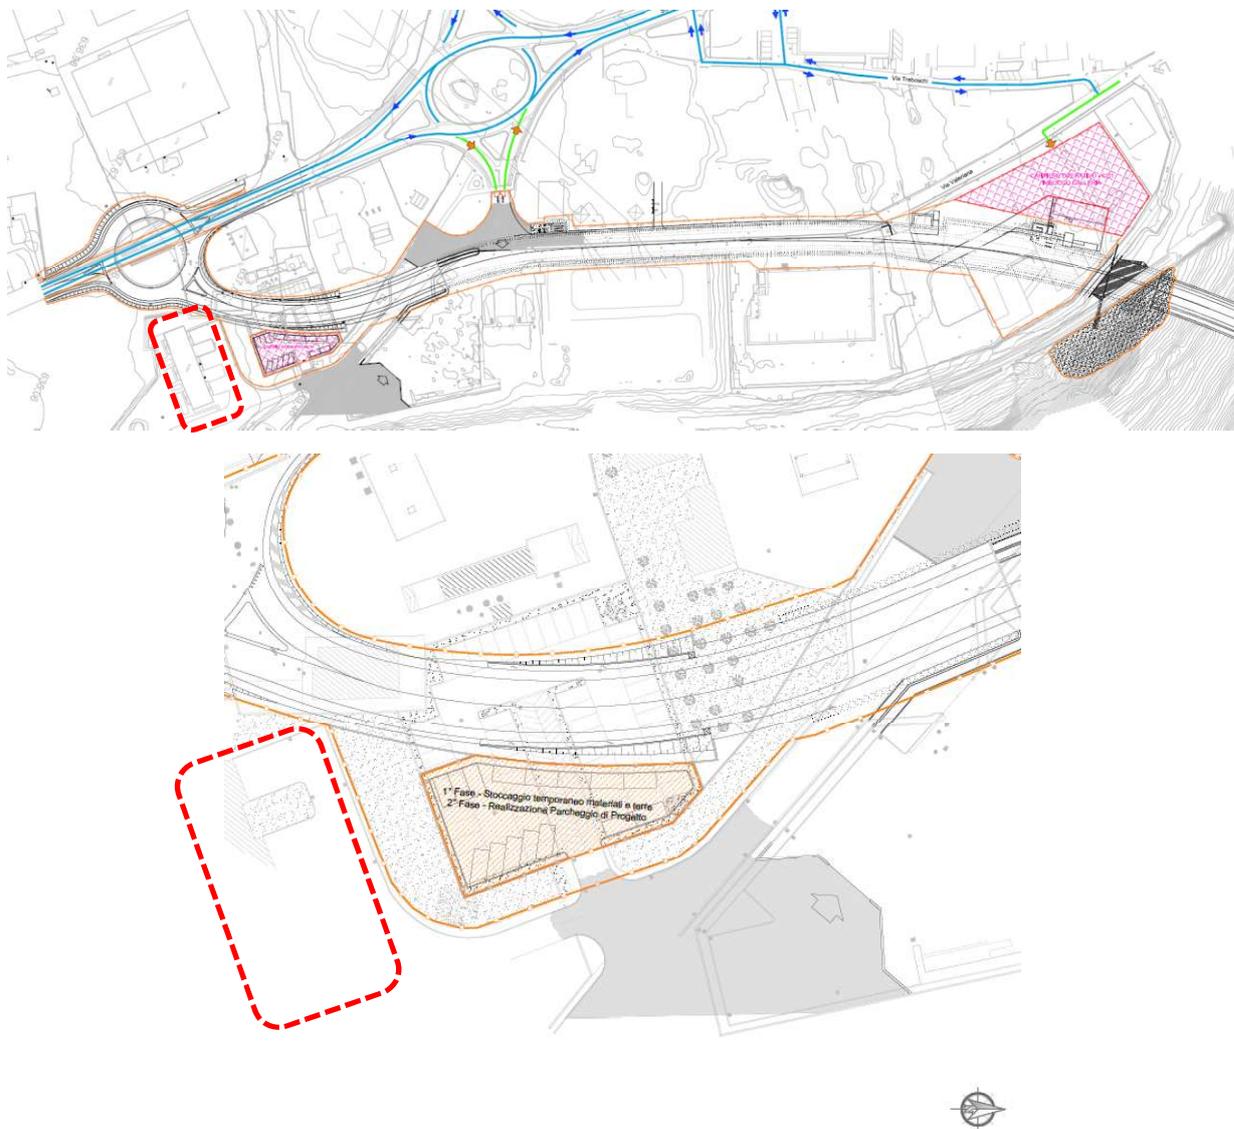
Planimetria aree di cantiere svincolo sud (in rosso tratteggiato la residenza degli Osservanti).
